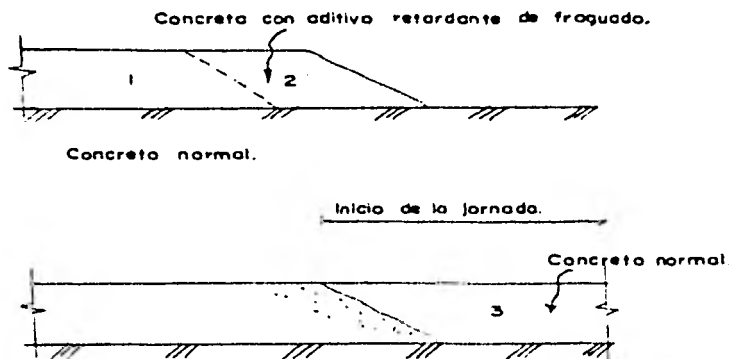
Junta diaria a base de concreto lanzada con un aditivo retardante de fraguado.
